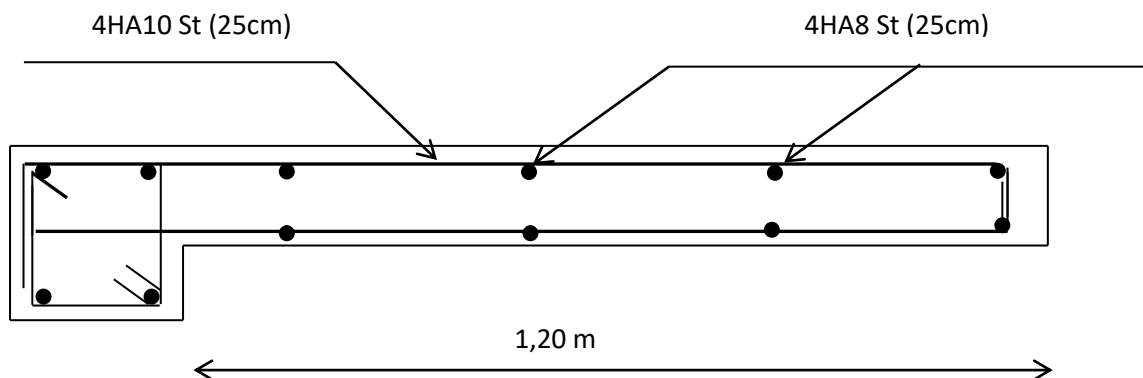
Ferrailage du balcon reposant sur deux appuis
